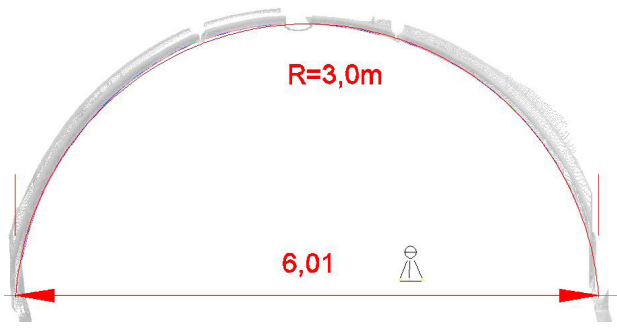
Vermessener Durchmesser und Radius; Rippe 2 im Joch 7
